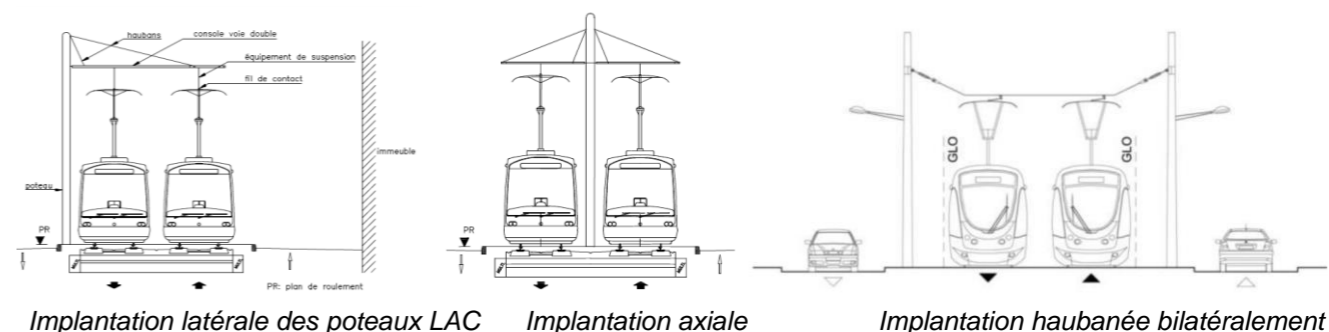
Exemples de poteaux/mâts et supports LAC (Source : photo ligne de Tramway T8 existante)
